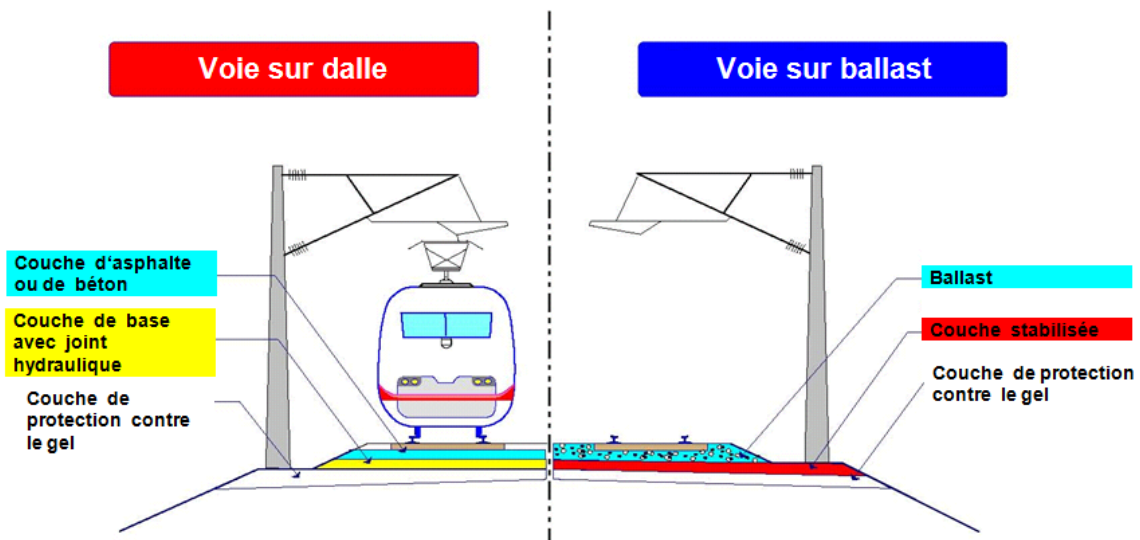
VOIE SUR BALLAST ET VOIE SUR DALLE
